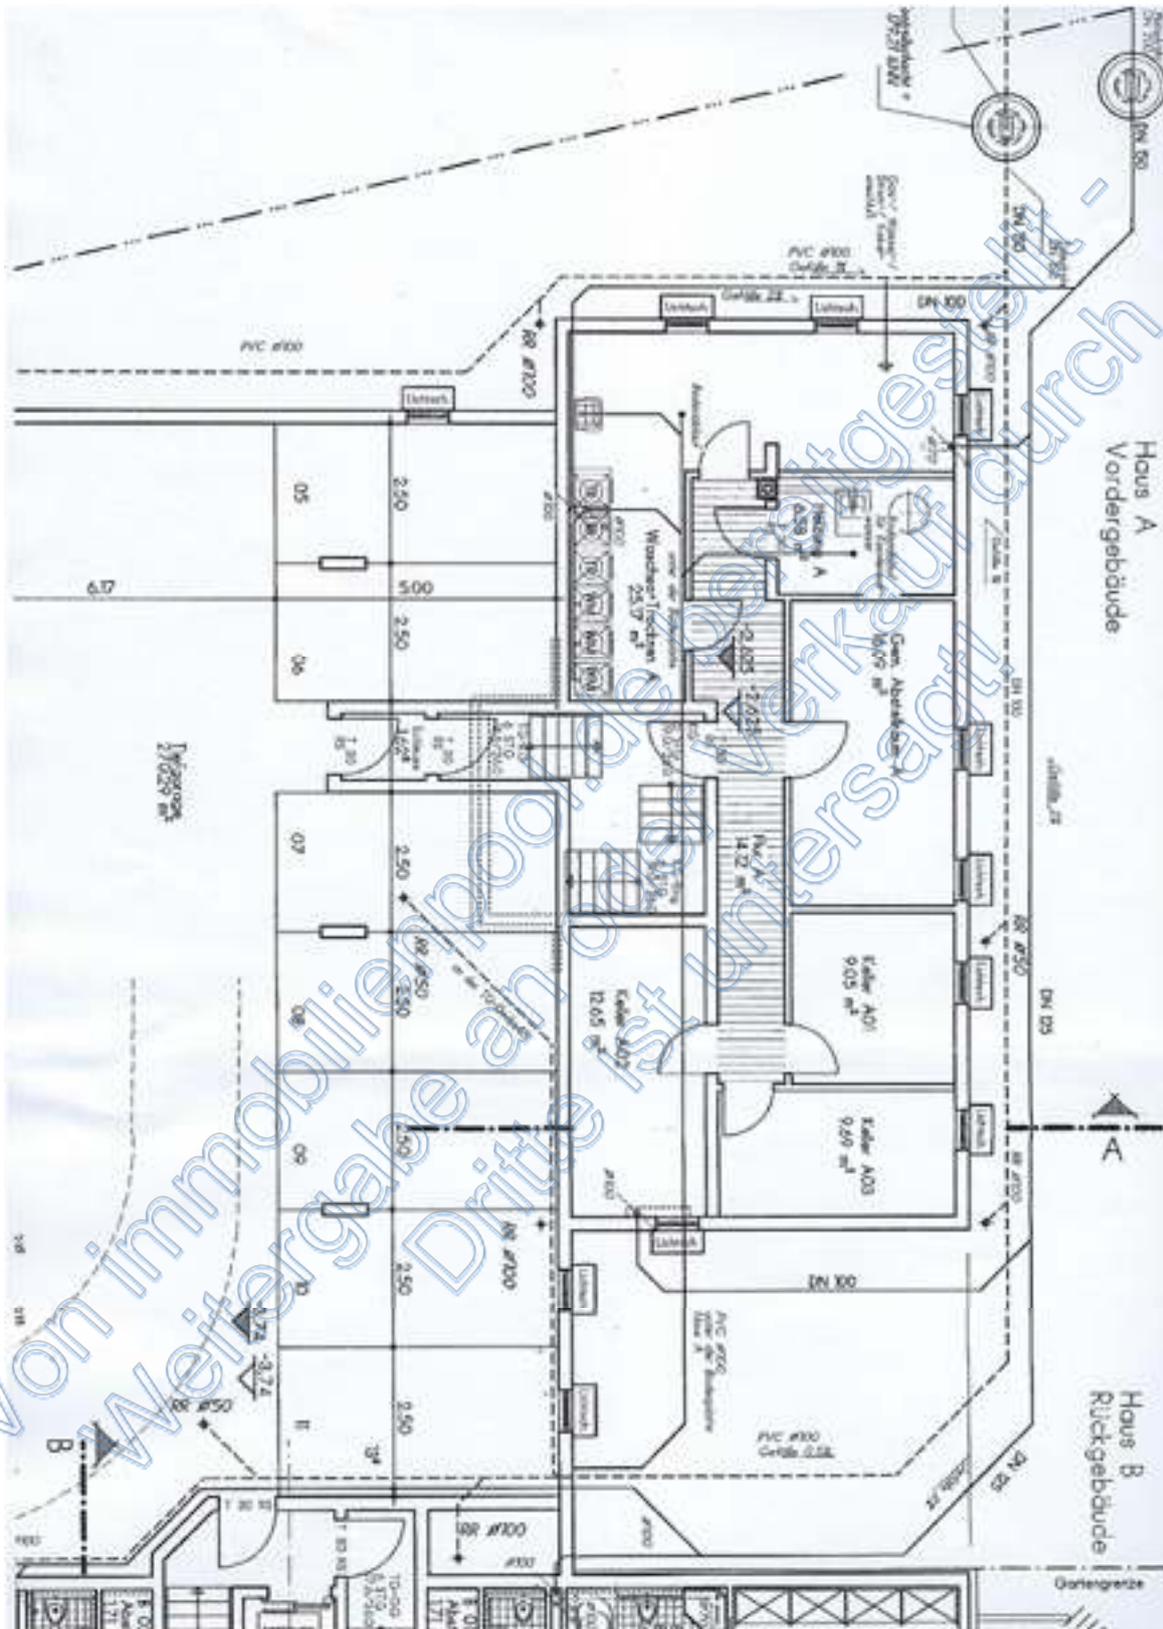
Grundriss des KG, Haus A mit der Wohnung zugeordnetem Kellerraum Nr.2.
